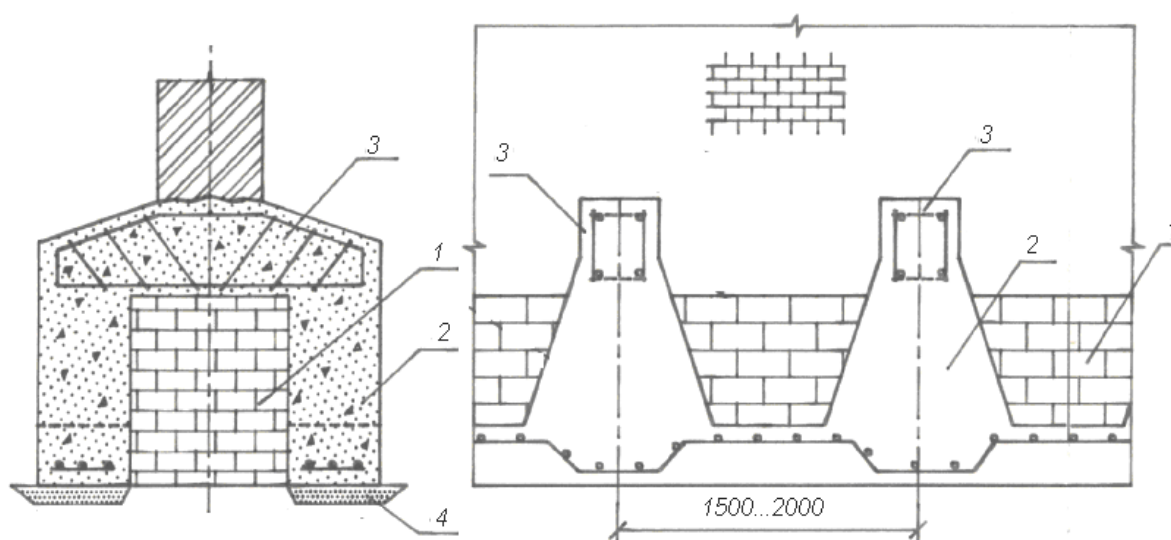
Уширение фундамента с применением поперечных железобетонных балок: а – поперечный разрез; б – вид сбоку: 1 – существующий фундамент; 2 – элементы уширения; 3 – железобетонная балка; 4 – подготовка
